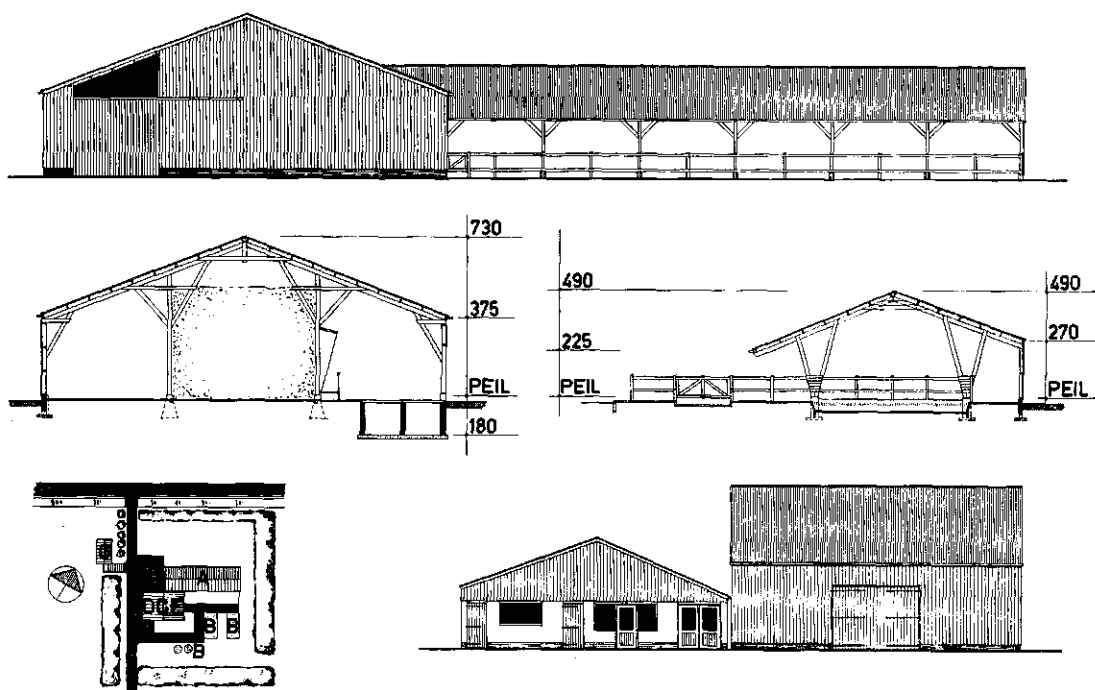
Plan E: gevels, doorsneden, erfindeling
